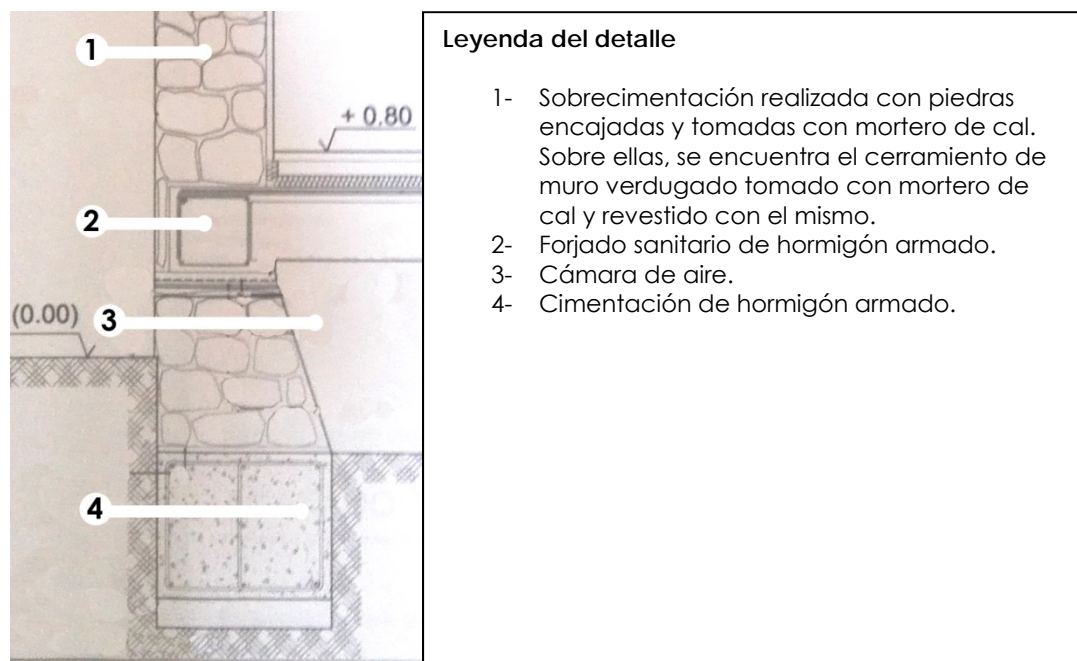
Cimentación y base del muro (SEV-002). Fuente: Autores del proyecto arquitectónico⁵⁰. Elaboración propia.
